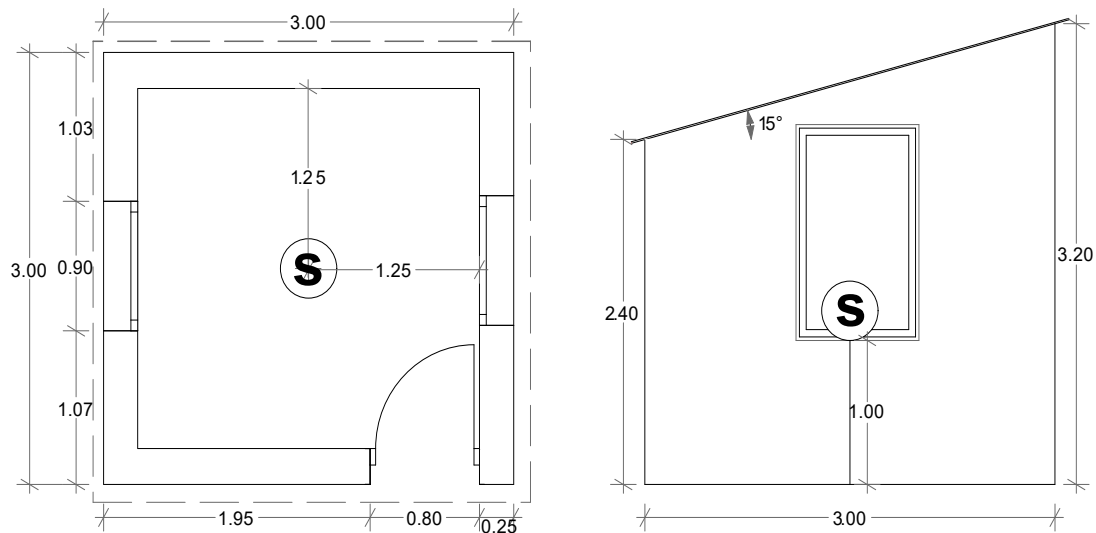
Dimensiones en planta y elevación del módulo A y B, la letra S inscrita en la circunferencia simboliza la ubicación del sonómetro en planta y elevación.
